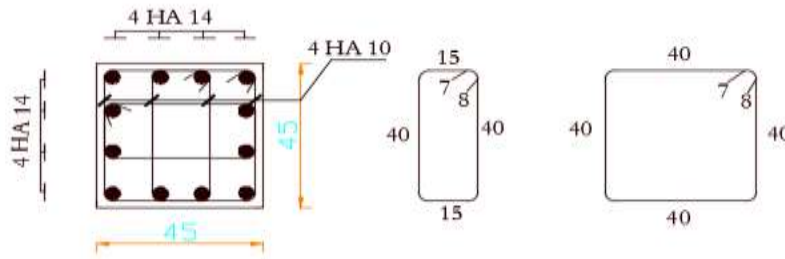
coupe transversale de ferrailage poteaux 45 x 45 cm²
